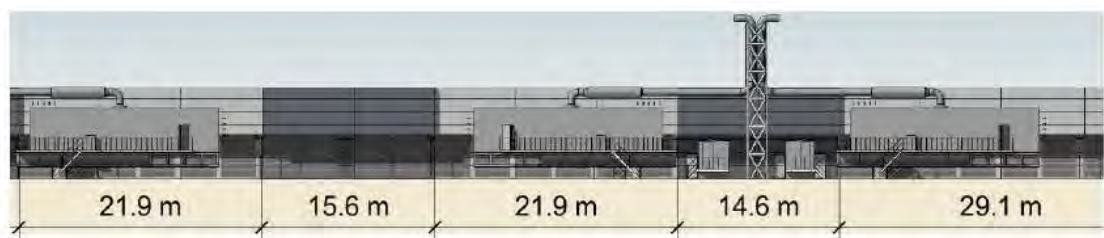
Concetto di interruzione facciate – Vista assonometrica
